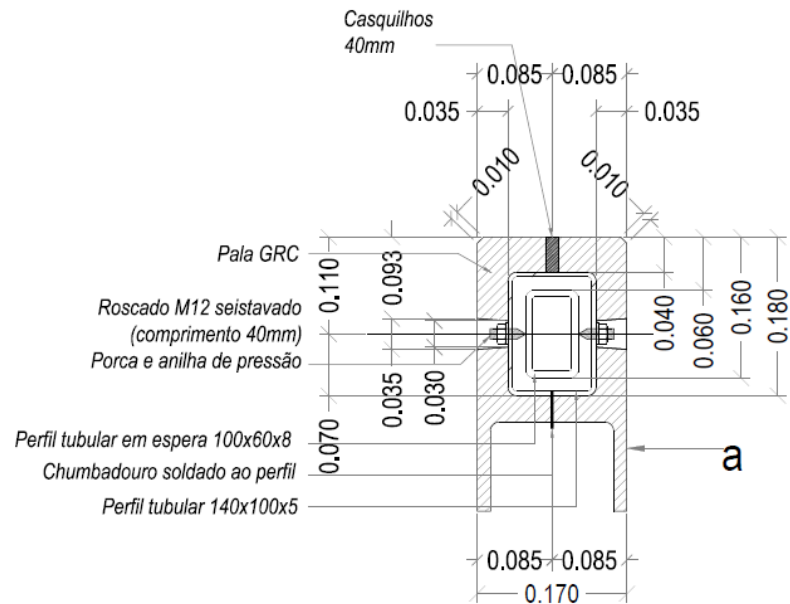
Corte da secção transversal da Figura 4.3 (dimensões em m)
